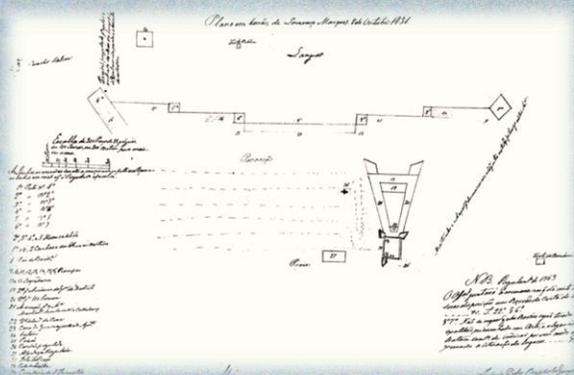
Plano em borrão, 1951 ( Fonte : Conservação da Arquitectura e ambiente
